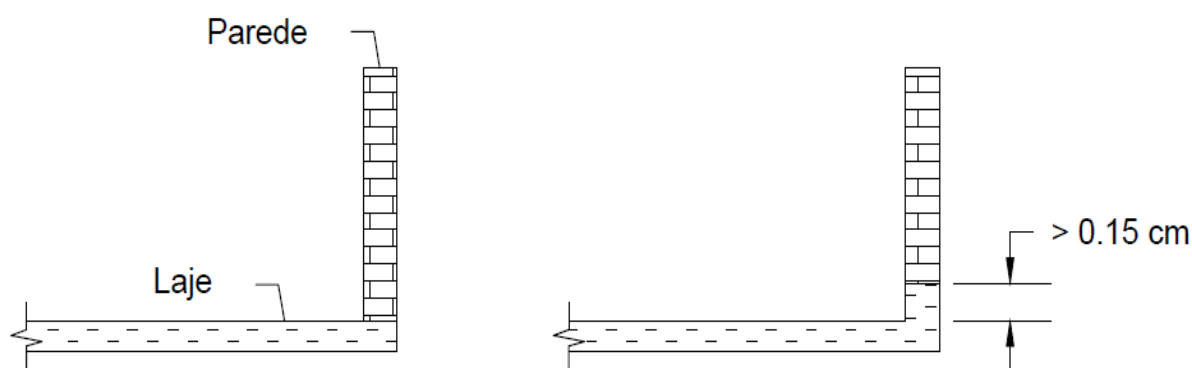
Parede a esquerda levantada sem a construção de parte em concreto, parede a direita construção de parte com concreto
